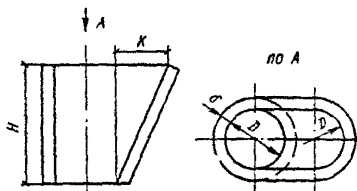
Конструкция стальных скоб-подкладок для сварки стыковых соединений вертикальных стержней
